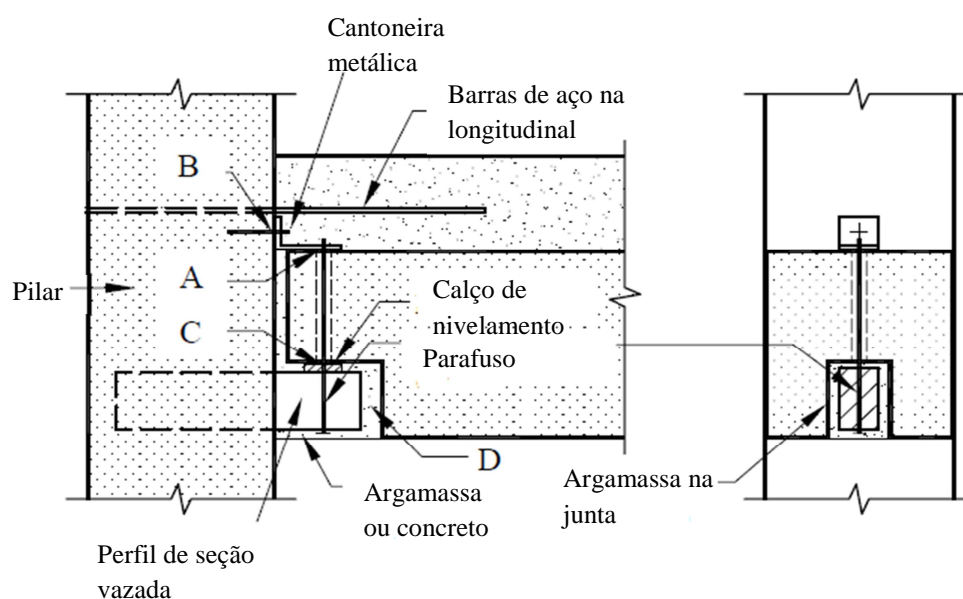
Mecanismo estrutural para ligação de extremidade de viga com perfil de aço [FIB (2008)].
